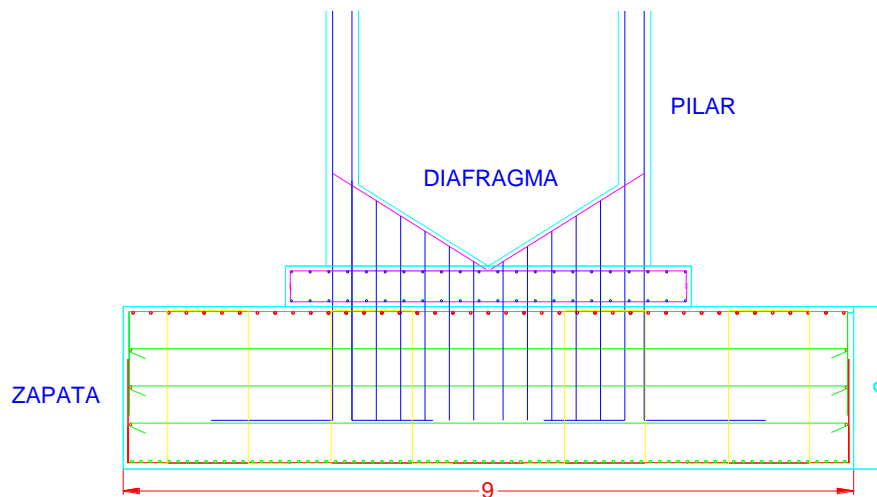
Conexión entre pilar y zapata de cimentación mediante un diafragma.
